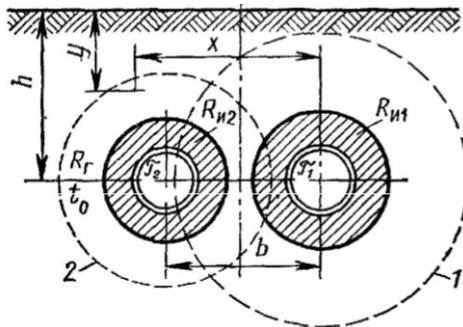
Расчетная схема бесканального двухтрубного трубопровода
